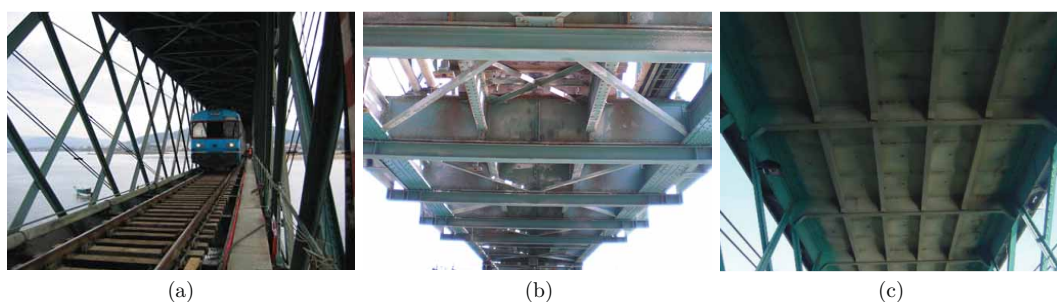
Pormenores da estrutura da Ponte Eiffel: a) vista geral das duas treliças; b) tabuleiro inferior; c) tabuleiro superior (antes da reabilitação).
